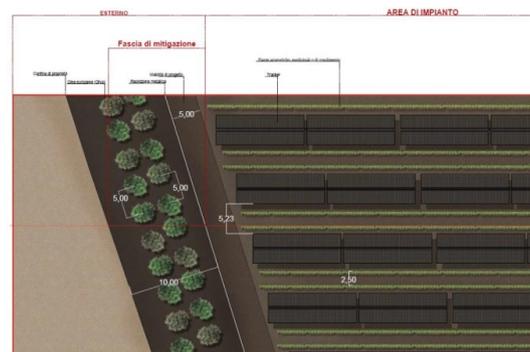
Planimetria dell'area di impianto con la coltivazione di piante aromatiche tra le file
